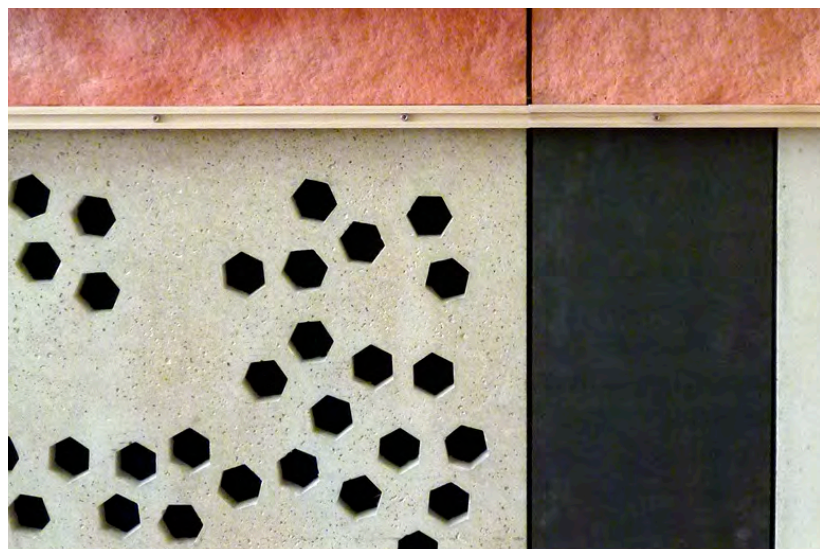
Ausschnitt Unterkonstruktion Demonstrationswand mit Montage der ersten Plattneriehe
